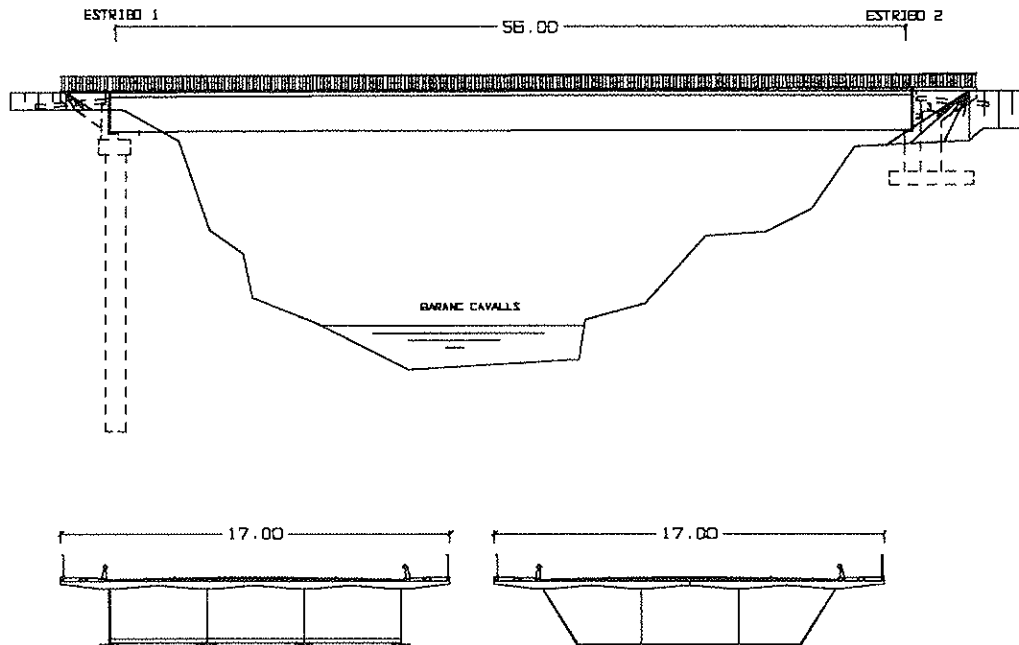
Solución n.º 1. Viga mixta simplemente apoyada, de canto constante.
